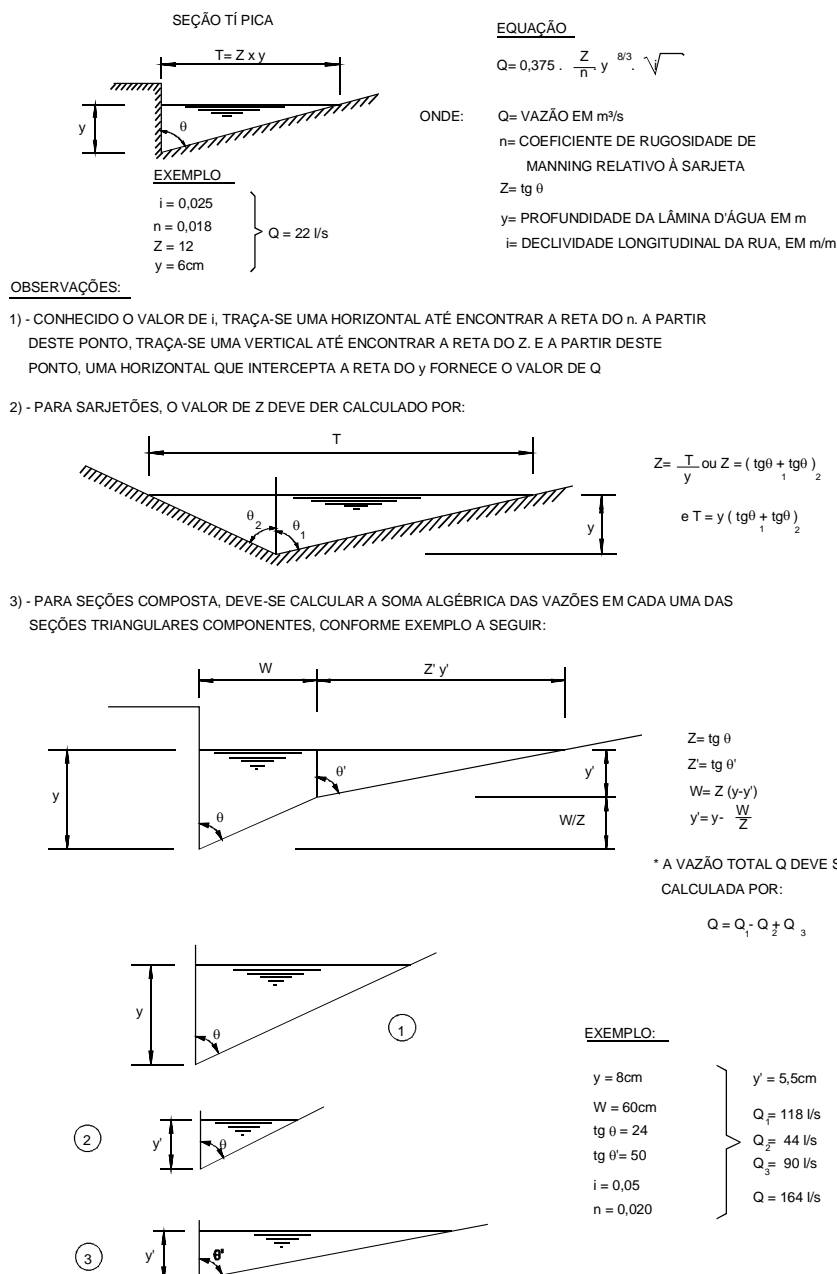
Instruções para a utilização da Figura 6.1.
